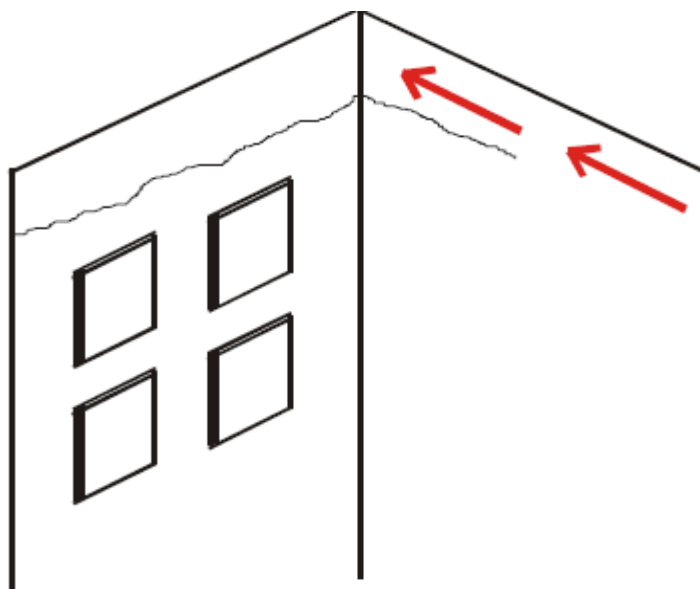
Fissura Horizontal na Interface entre laje e a parede por movimentação térmica da laje
